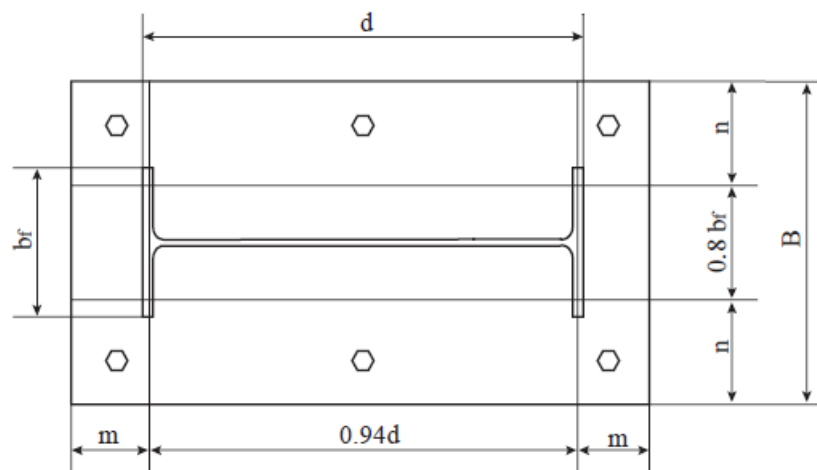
Detalle de conexión placa-base (con carga horizontal)
